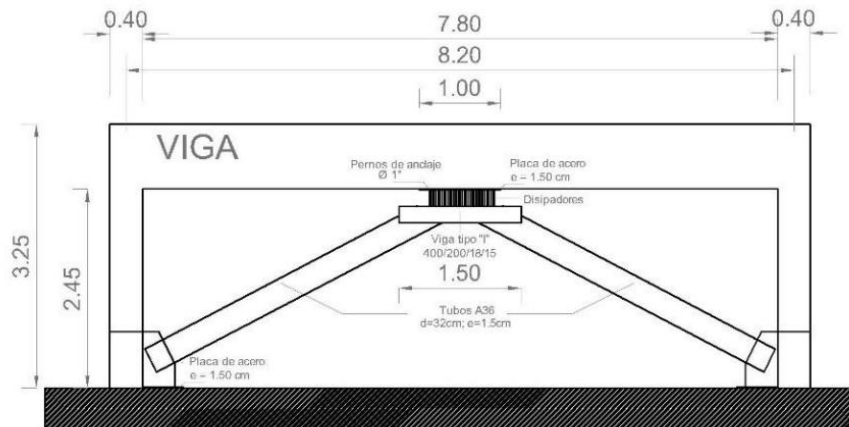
dimensiones de los TADAS instalados en la planta baja. Fuente: Aguiar et al. (2018)
